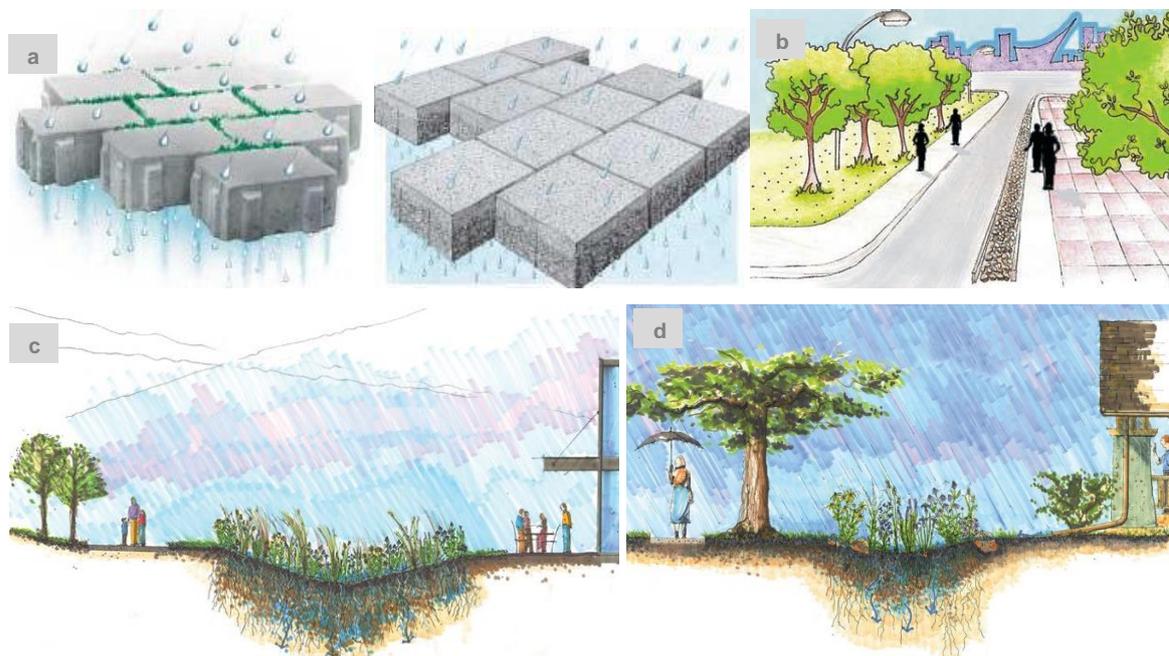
Estruturas de drenagem sustentável: a) Pavimentos permeáveis; b) Trincheira de infiltração; c) Vala de infiltração; d) “Rain garden”.
